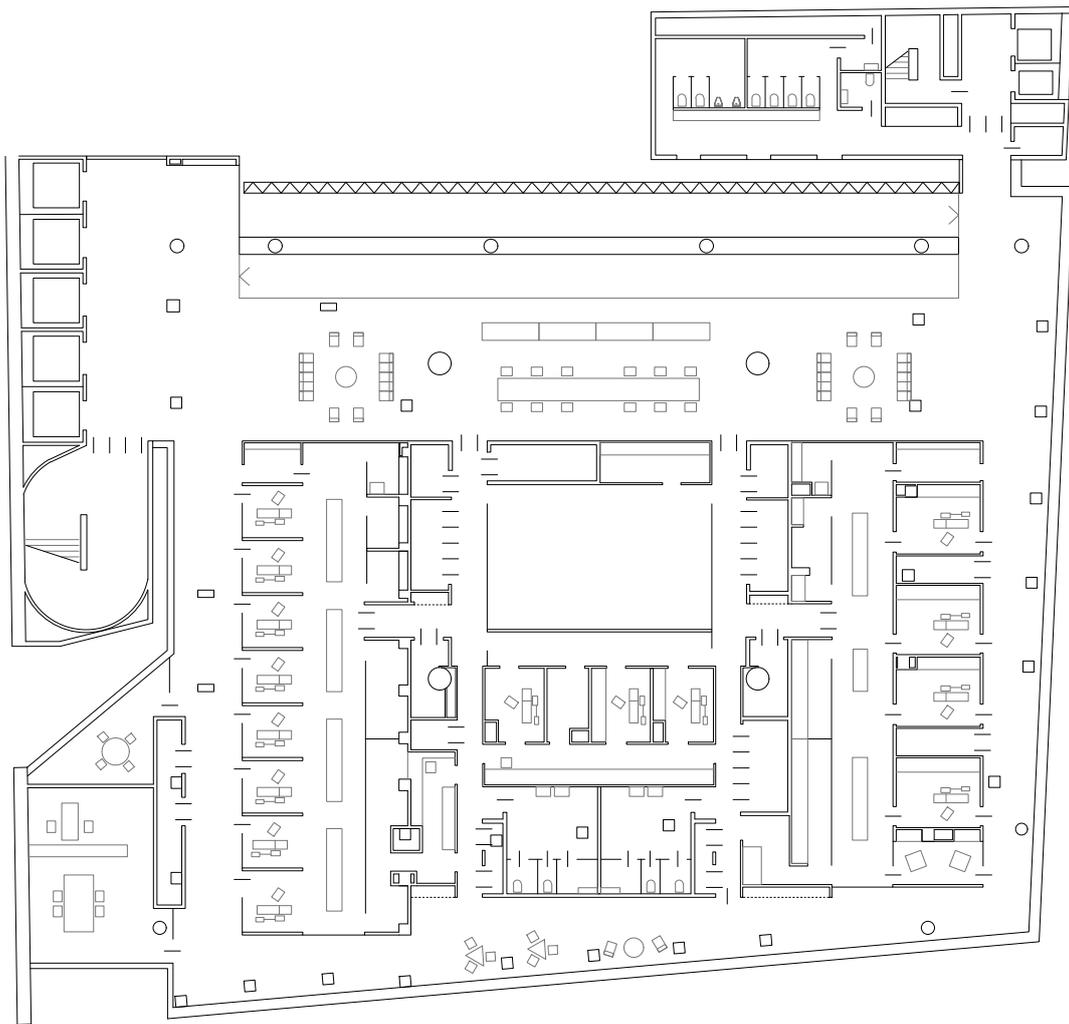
Grundriss 7. OG, Sesc 24 De Maio
